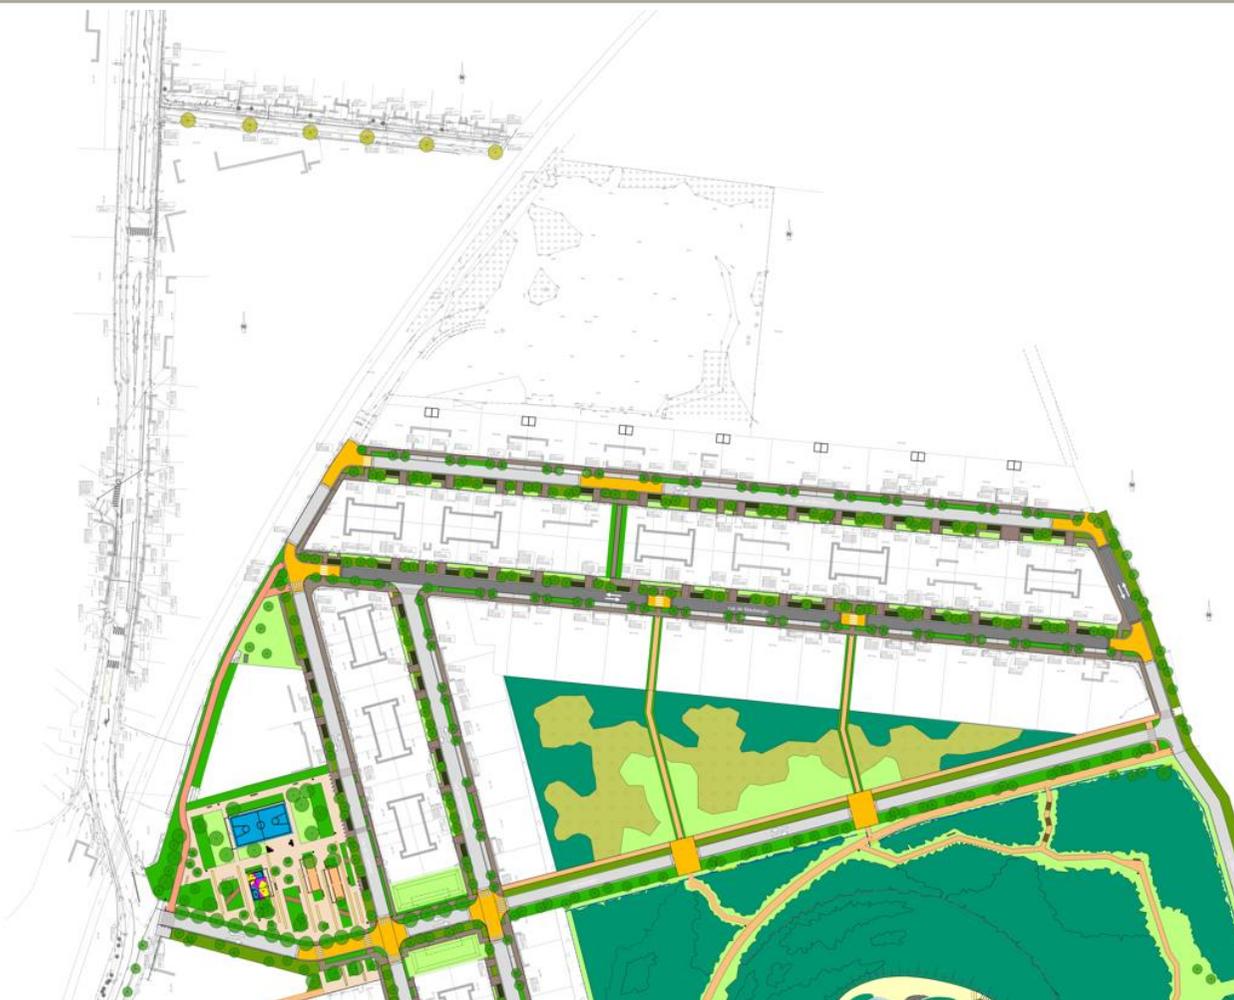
Extrait du plan masse – partie Nord, source : Paysage
